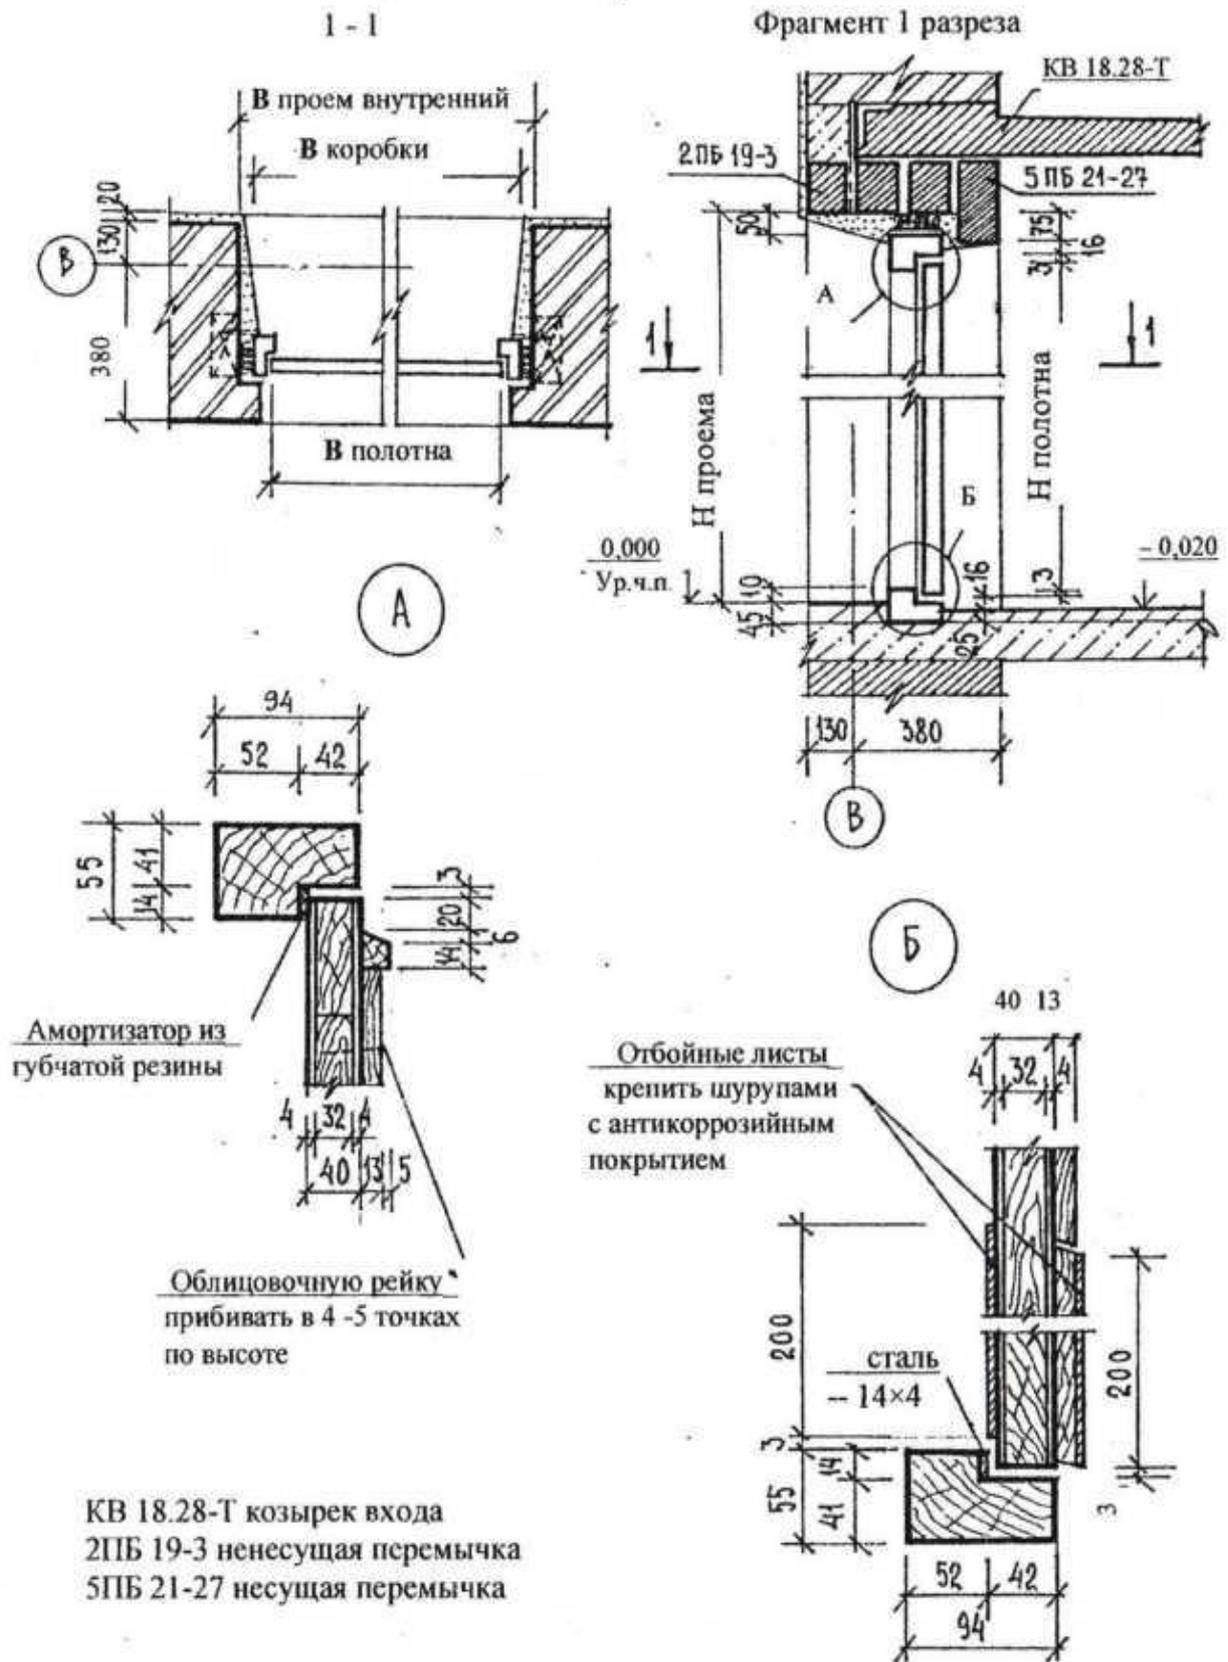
Схема определения конструктивных размеров дверных проемов, дверных полотен и схема укладки перемычек над проемом
